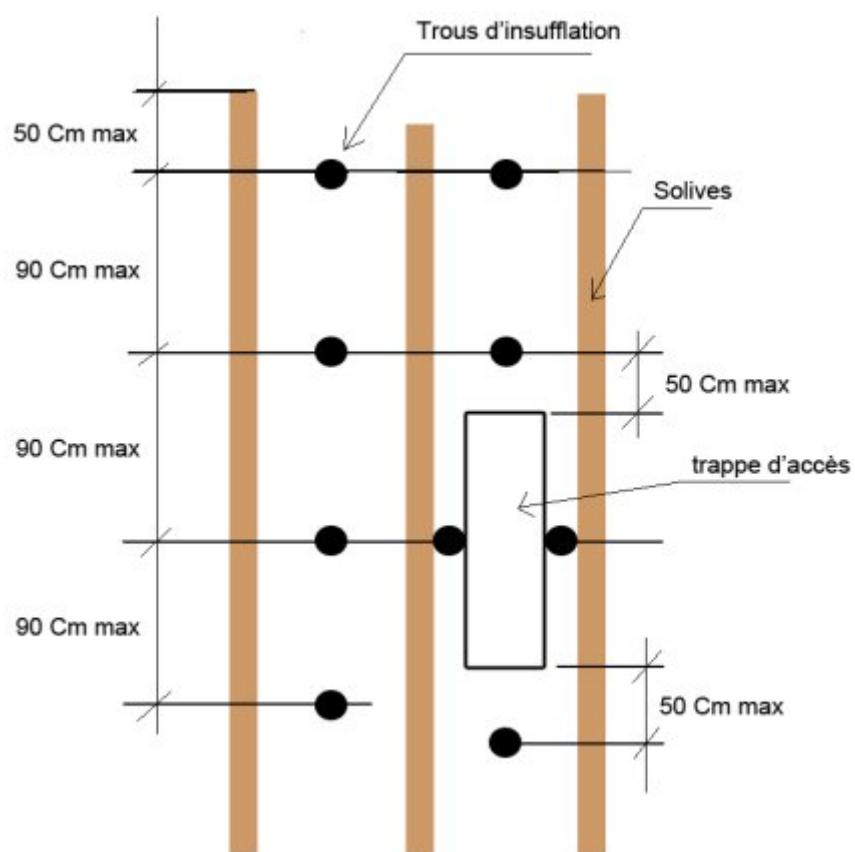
Insufflation par-dessus ou par-dessous le plancher
